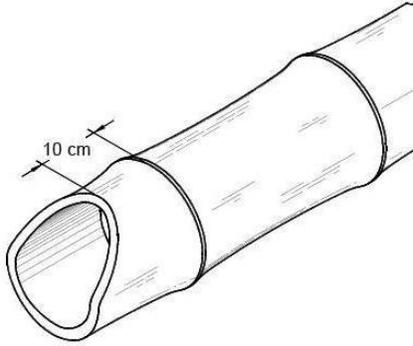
G.12.11-3 - Corte Pico de flauta
